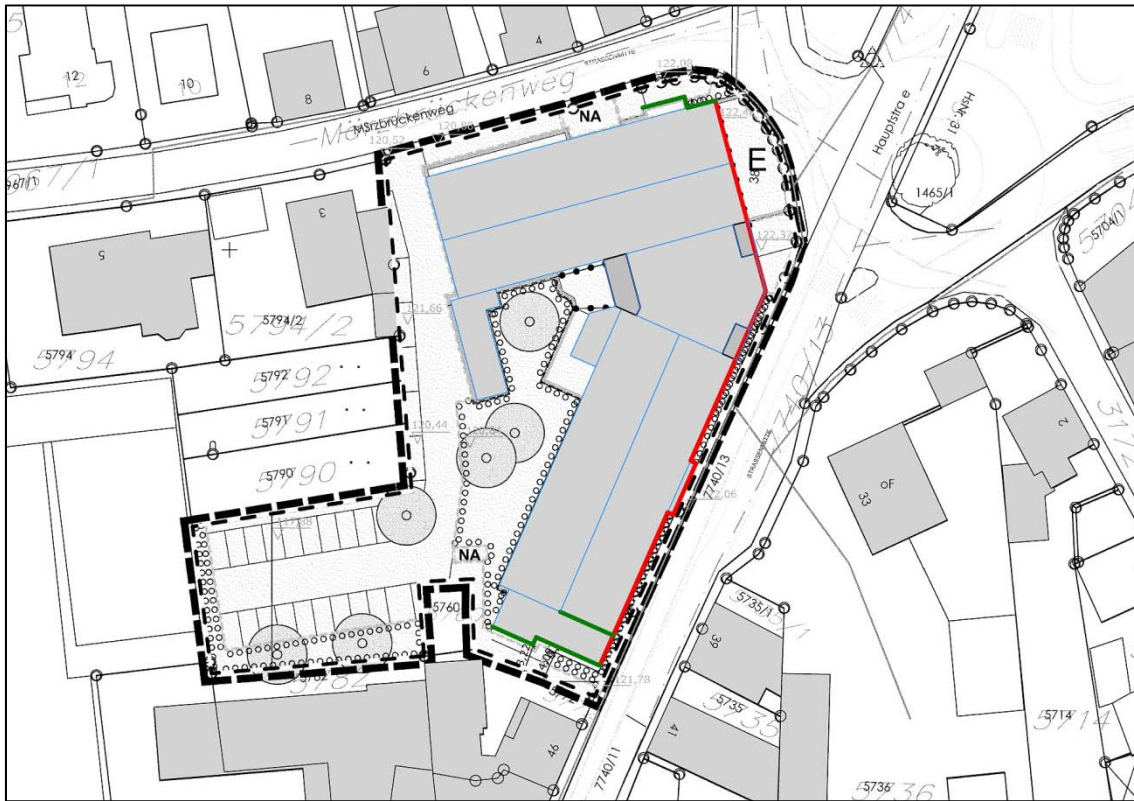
Lageplan mit Kennzeichnung der Fassaden, an denen Schallschutzmaßnahmen erforderlich sind
